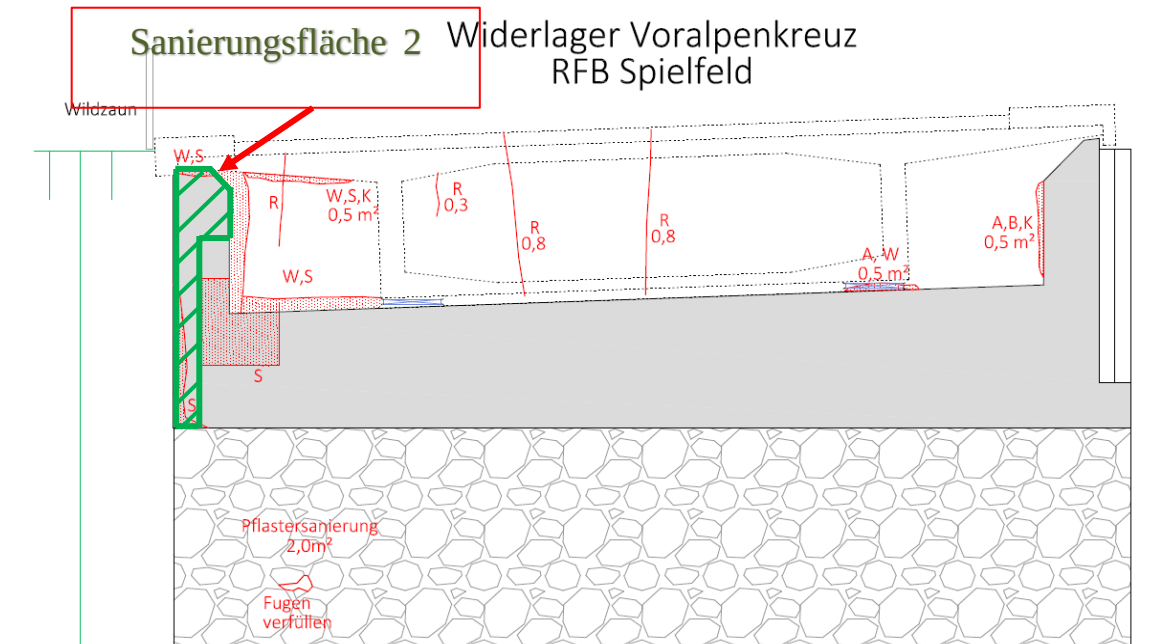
Sanierungsfläche 2 - Auszug aus dem Plan: Sanierung Objekt E32 Gabersdorf
